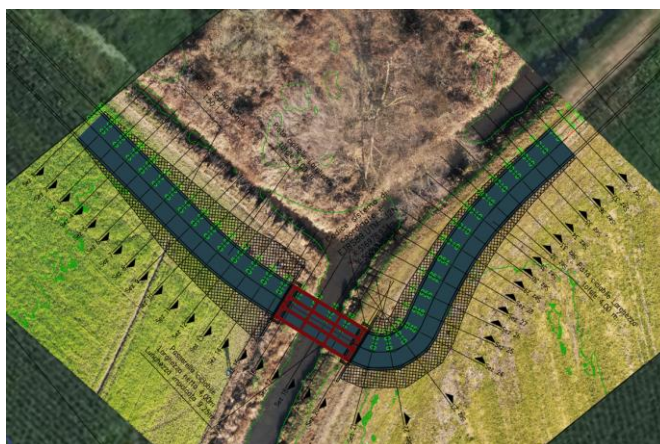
Planimetria del tracciato (locale) – Ponte pedonale 2B
